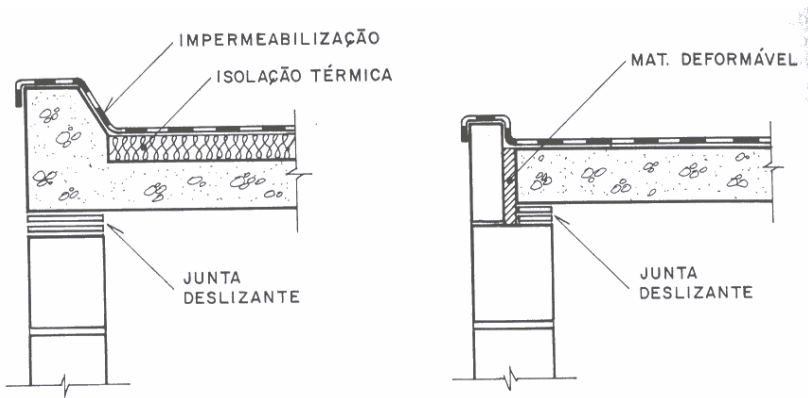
Junta deslizante entre laje de cobertura e alvenaria estrutural
